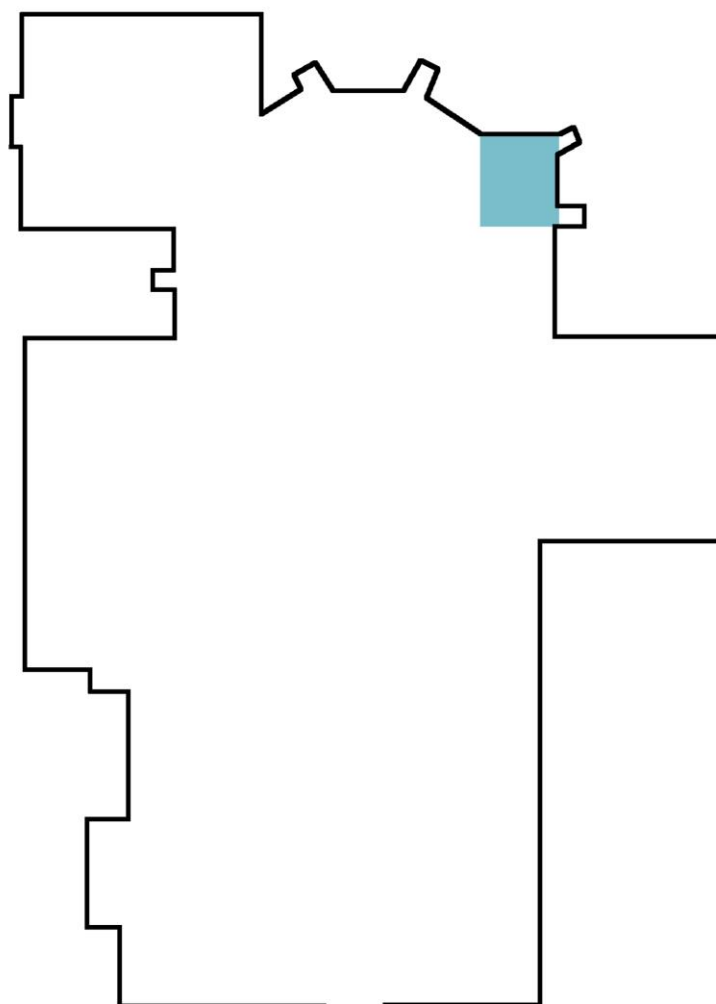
Plano de la planta de la iglesia Sta. María del Mercado.
